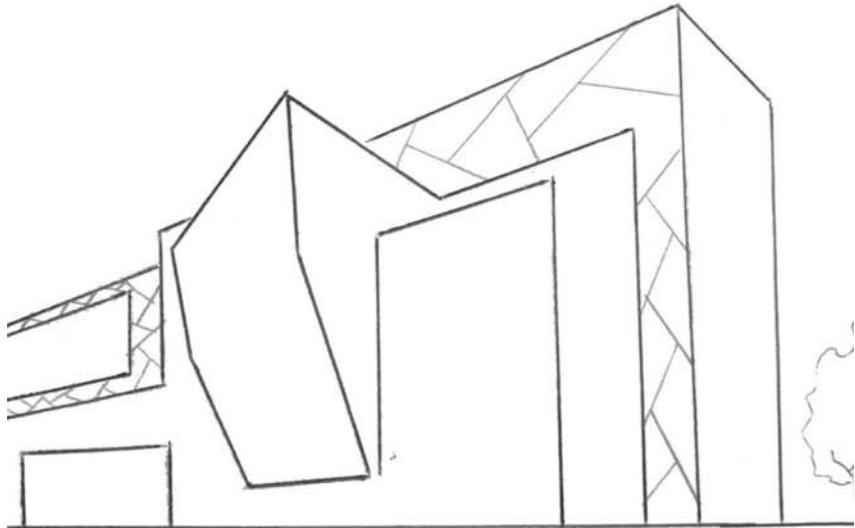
Boceto primera idea. Autor: Cynthia Alvarado.
